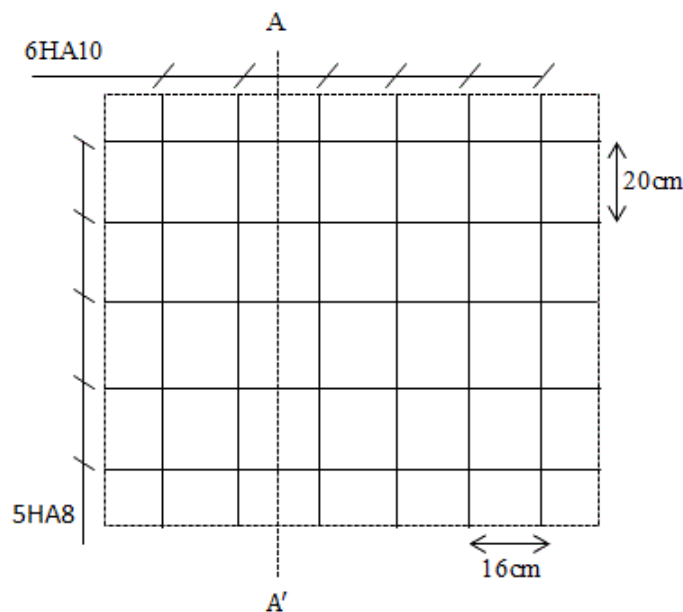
Schéma de ferrailage du voile périphérique.
